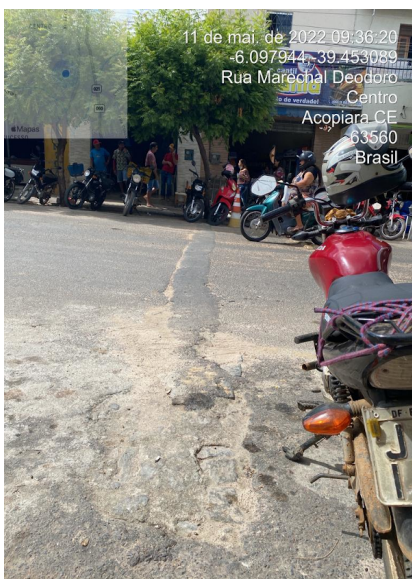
Rua Marechal Deodoro, Centro: pavimento sem recuperação.
